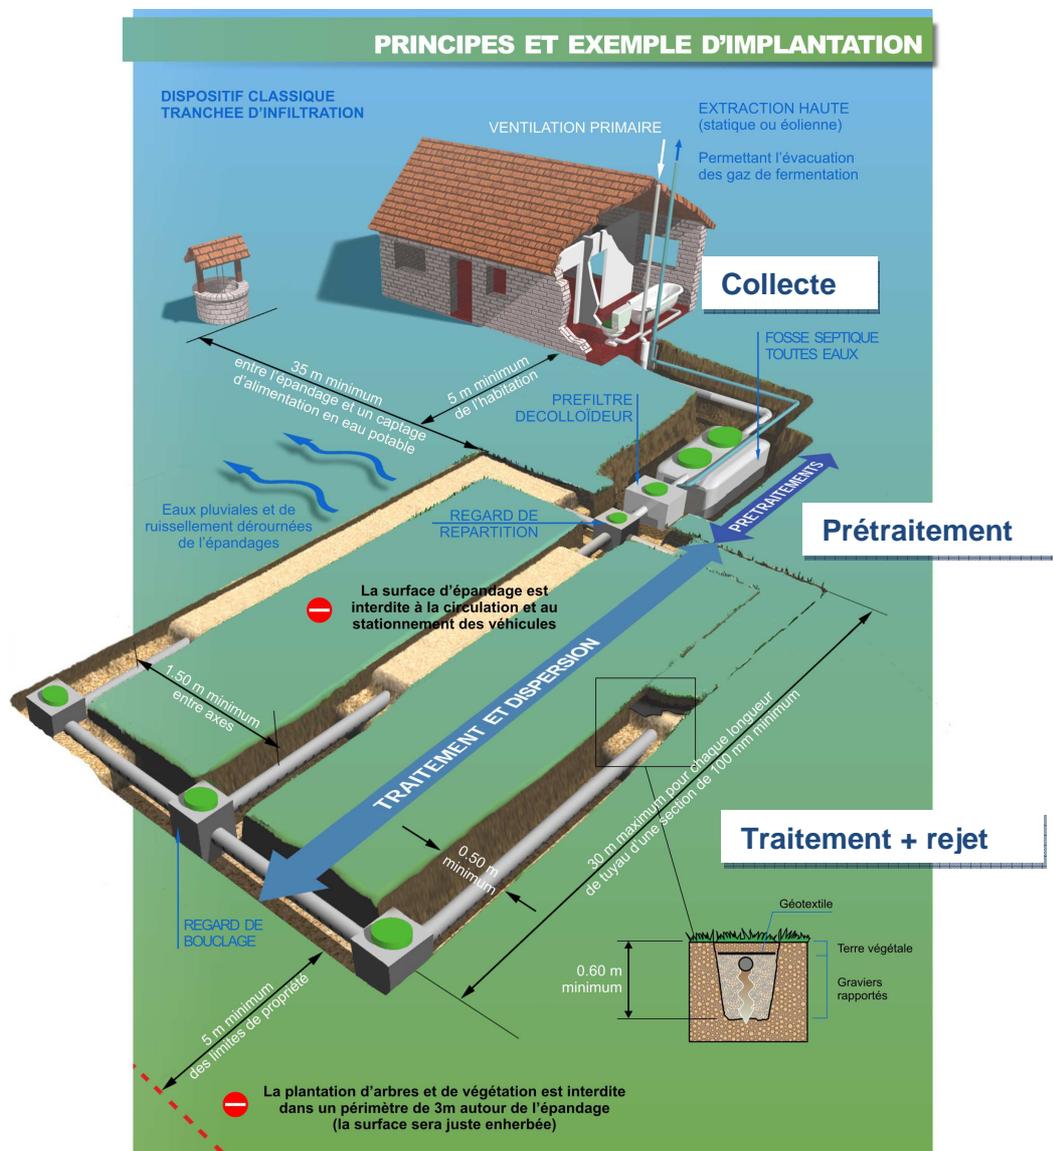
Schéma de principe d'une installation d'assainissement non collectif
